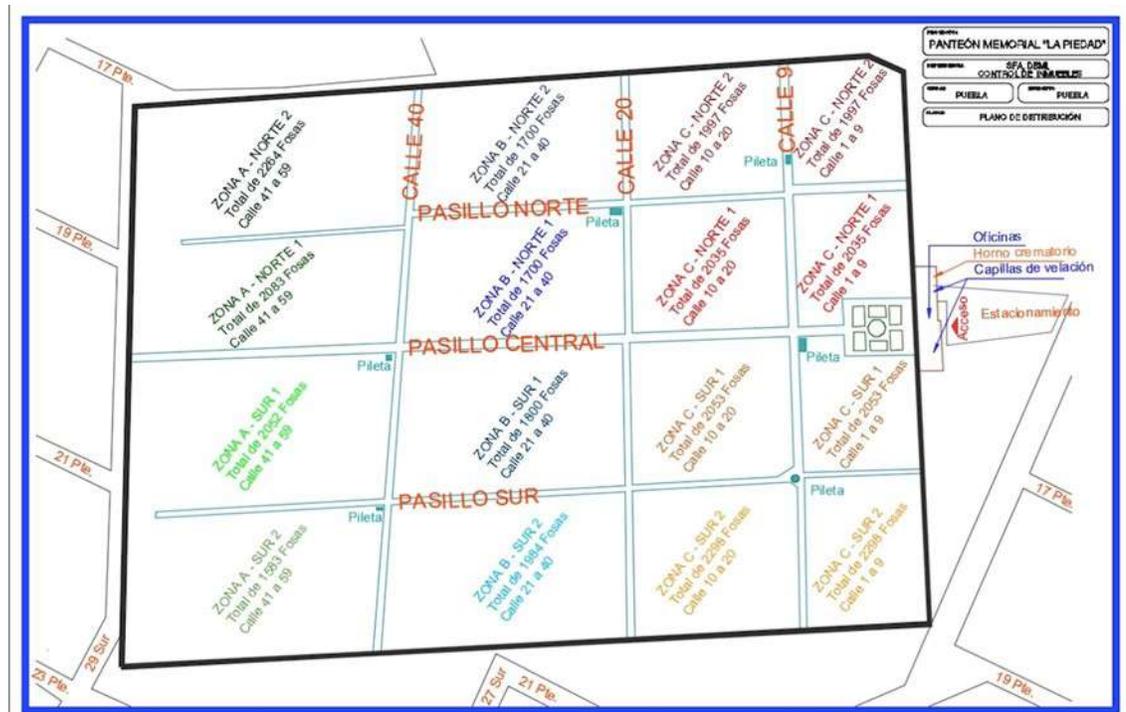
Plano del cementerio de la piedad. división general del panteón, número de fosas y principales puntos. Plano de la dirección de bienes muebles e inmuebles del Estado de Puebla.
